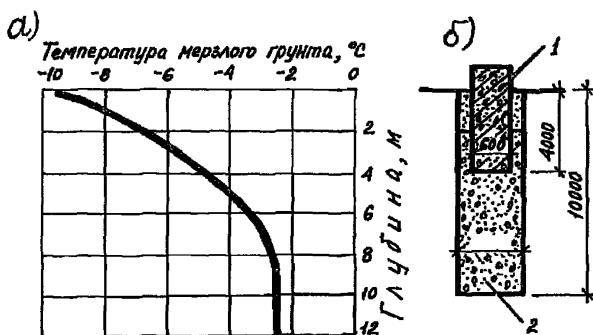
Температура грунта (а) и схема комбинированной свей (б): 1-сборный железобетонный элемент, 2-монолитный бетон
